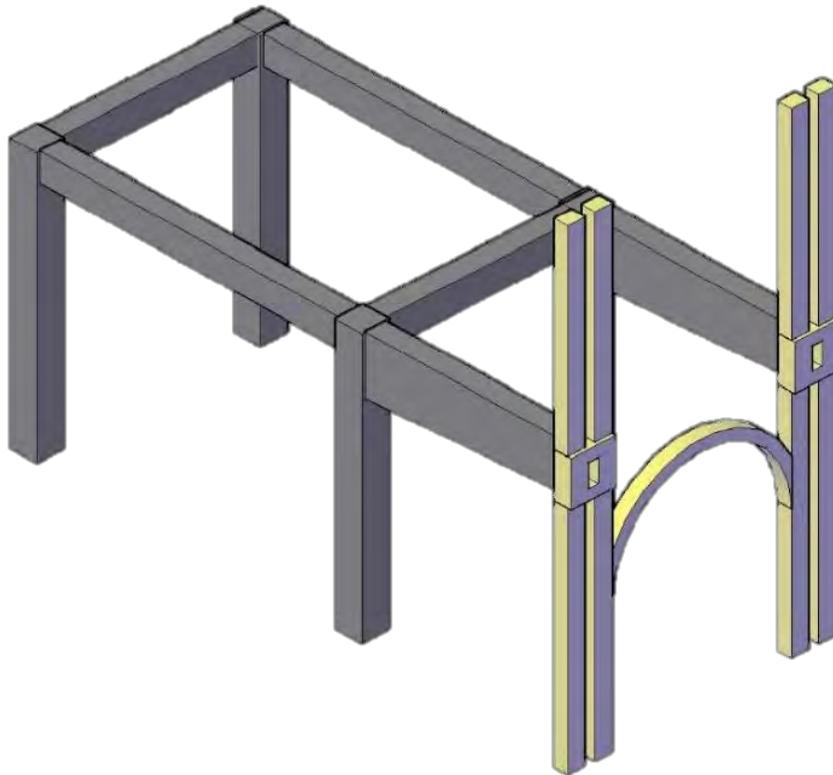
Estructura de la planta baja. En tono oscuro se aprecia la unión de los marcos rígidos con sus respectivas ménsulas, en tono claro las columnas ornamentales de la fachada principal.
